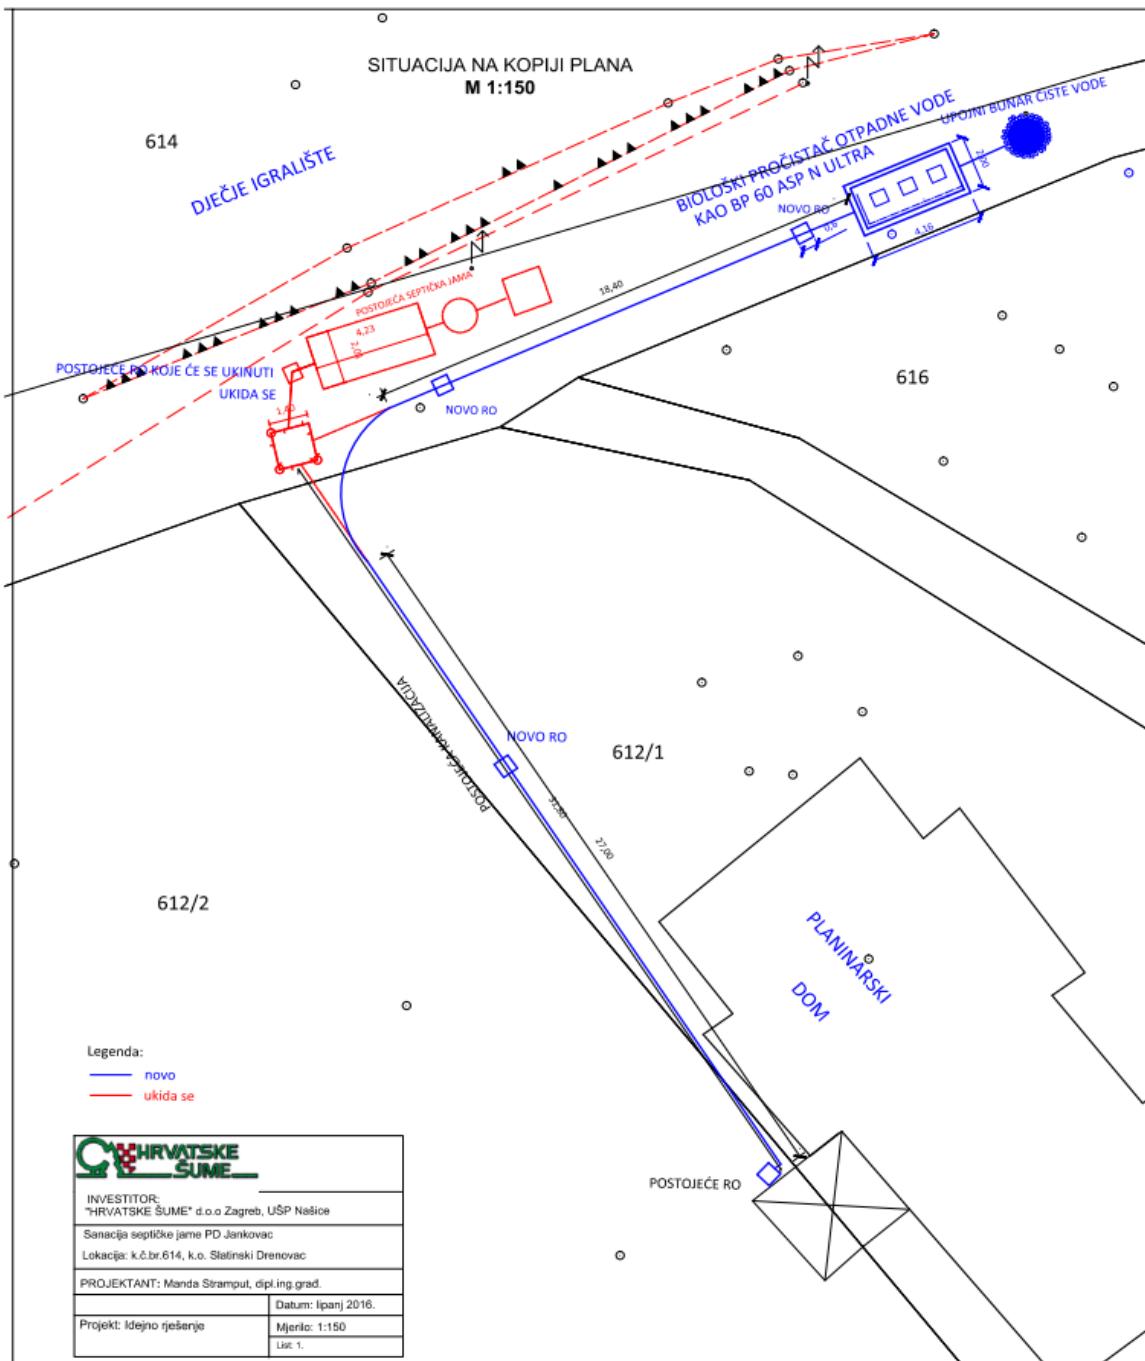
Lokacija zahvata – planinarski dom Jankovac
